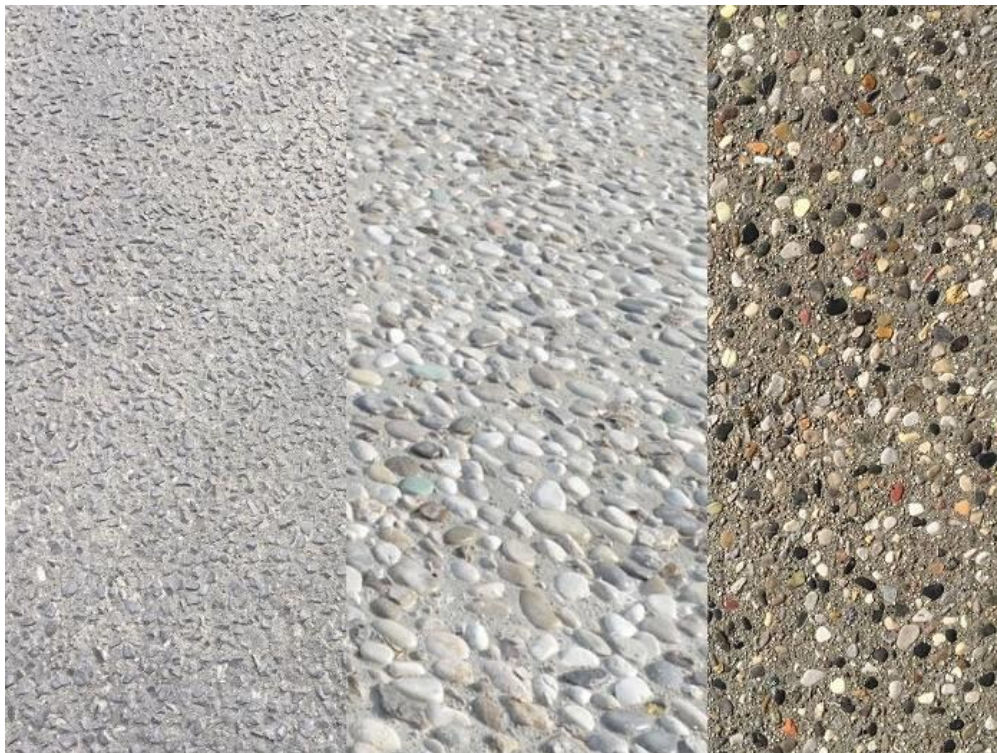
Dettaglio di calcestruzzi lavati con inerte a vista
